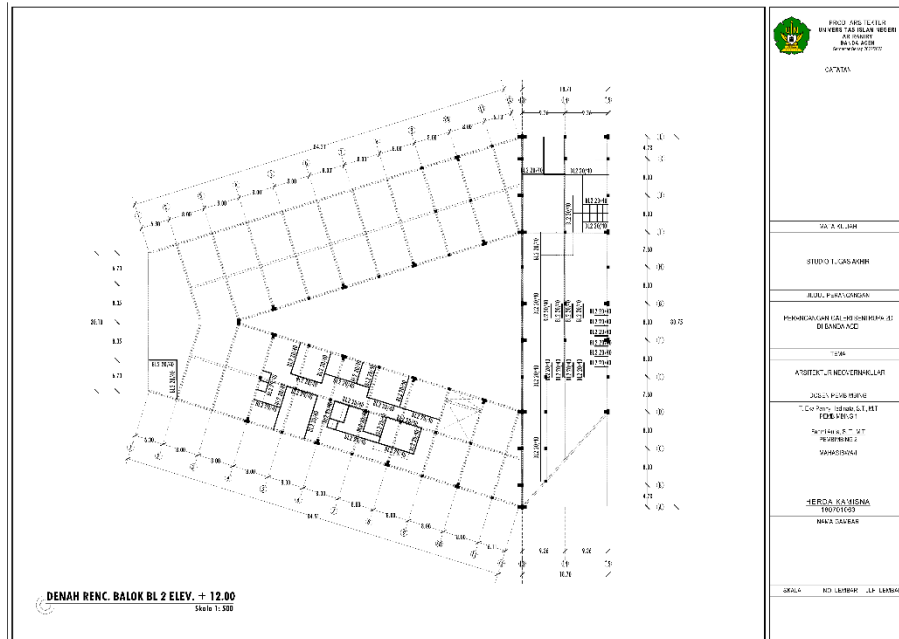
51 Denah Rencana Balok BL 1 Elv. +12.00
